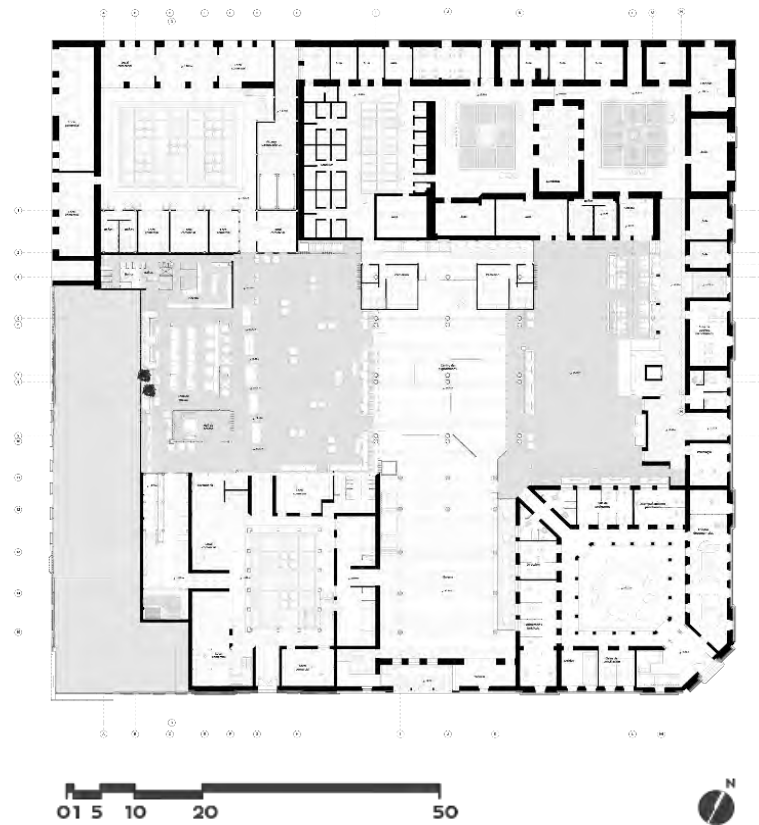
Planta General Estructural. Fuente: Elaboración Propia.
